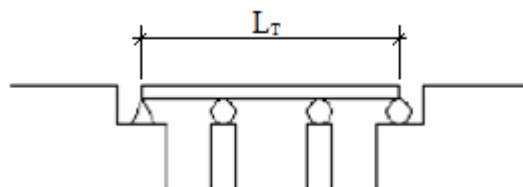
Longitud de dilatación puentes de múltiples vanos con un apoyo fijo
